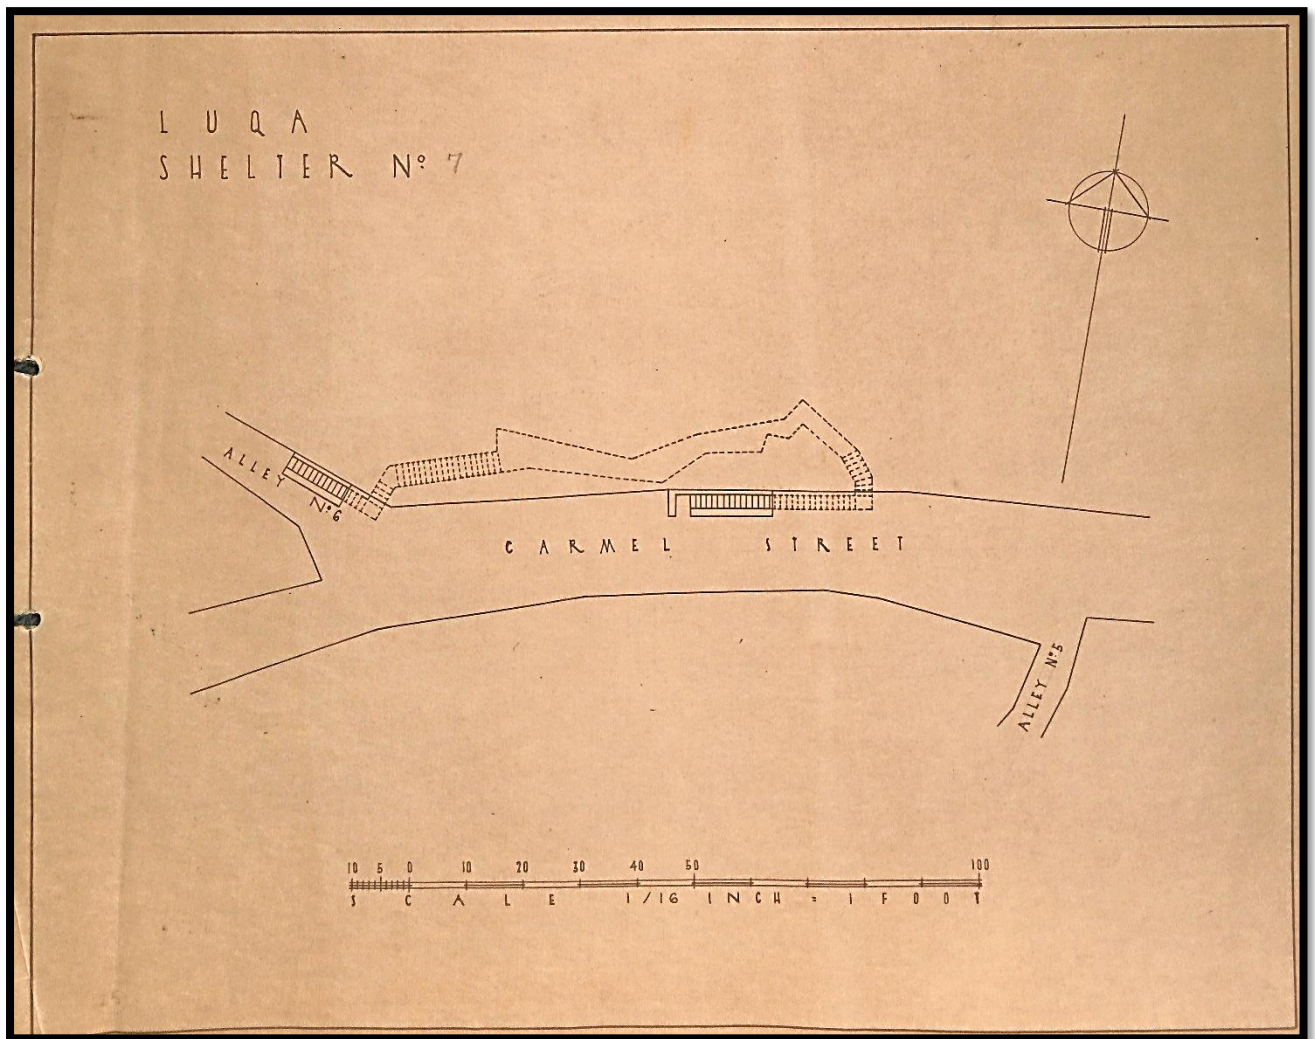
Planta do Abrigo nº7 "Carmel Street – Alley nº6 –Alley nº5"
